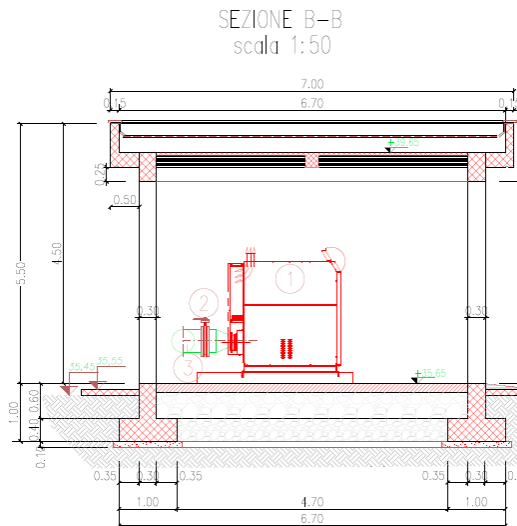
Pianta e sezioni del nuovo locale alloggio soffianti
